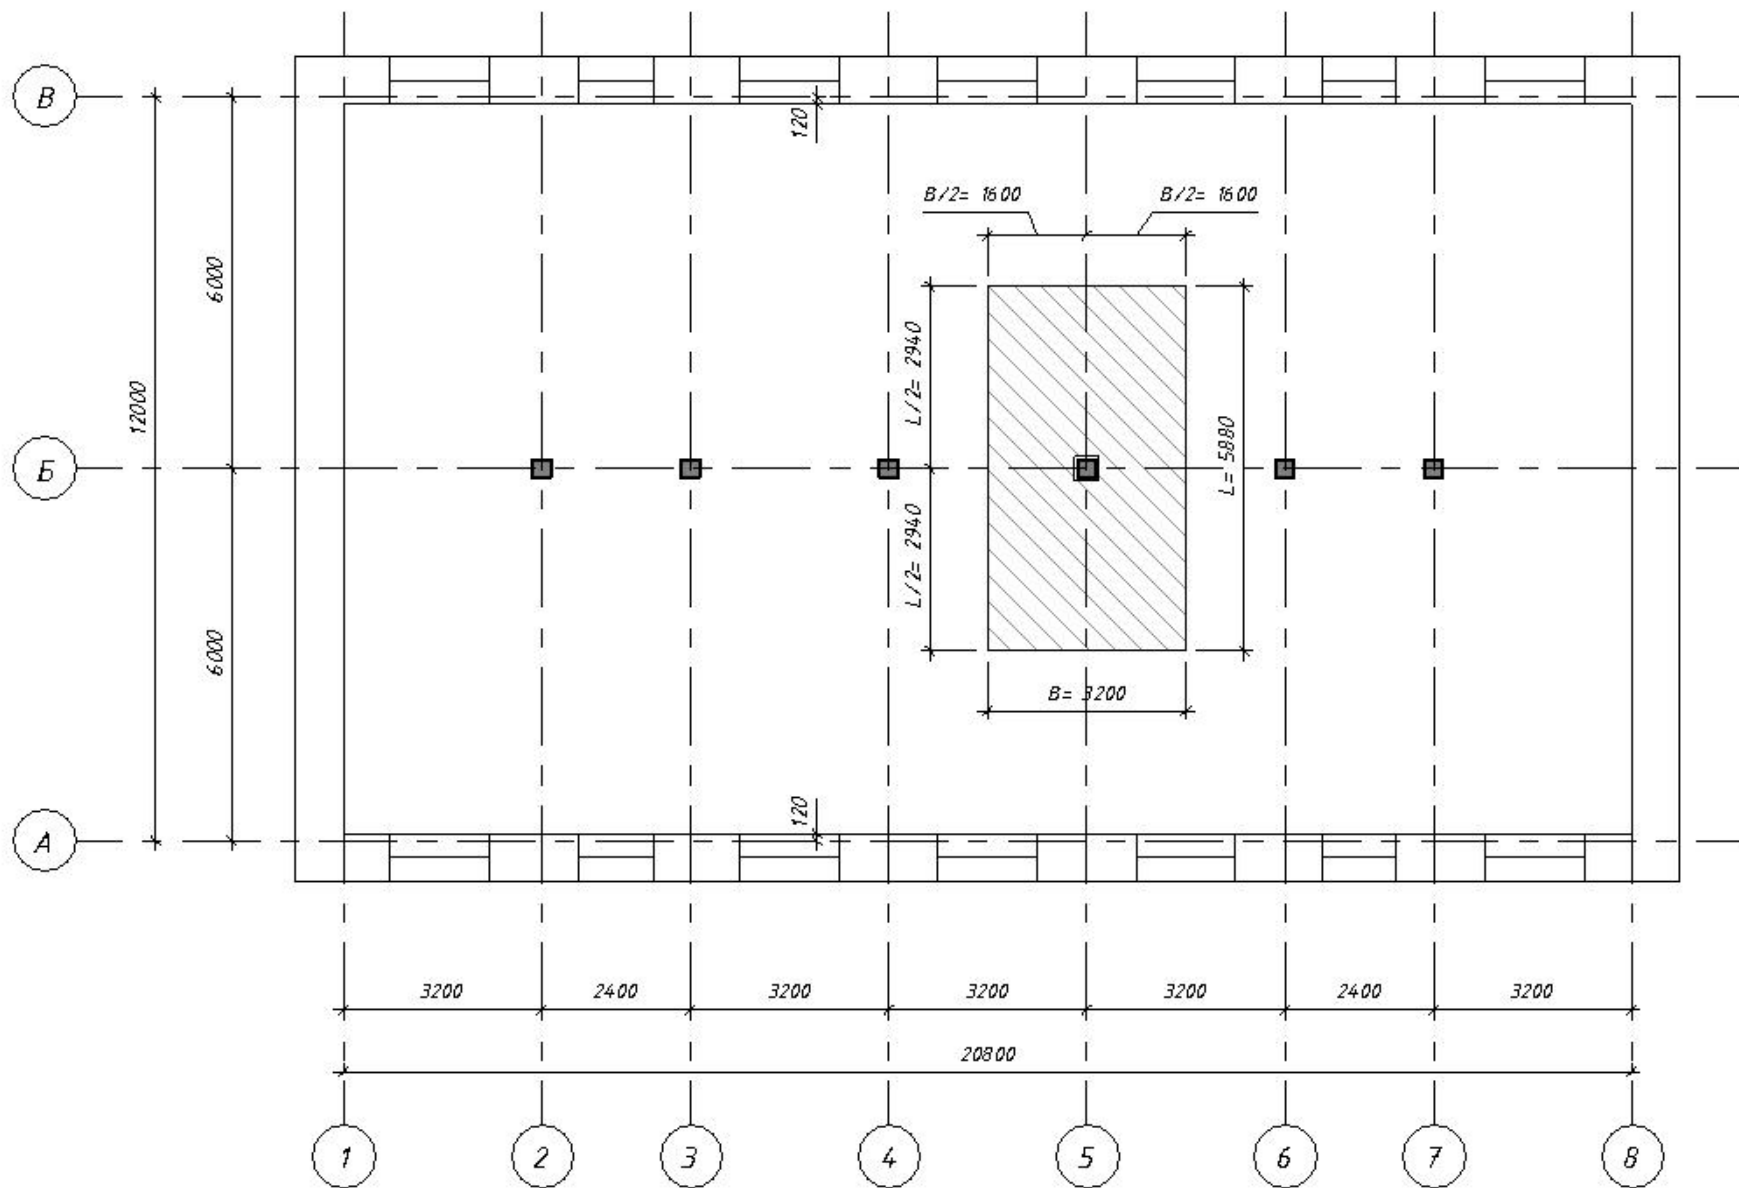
Размер грузовой площади при сборе нагрузок на колонну здания
